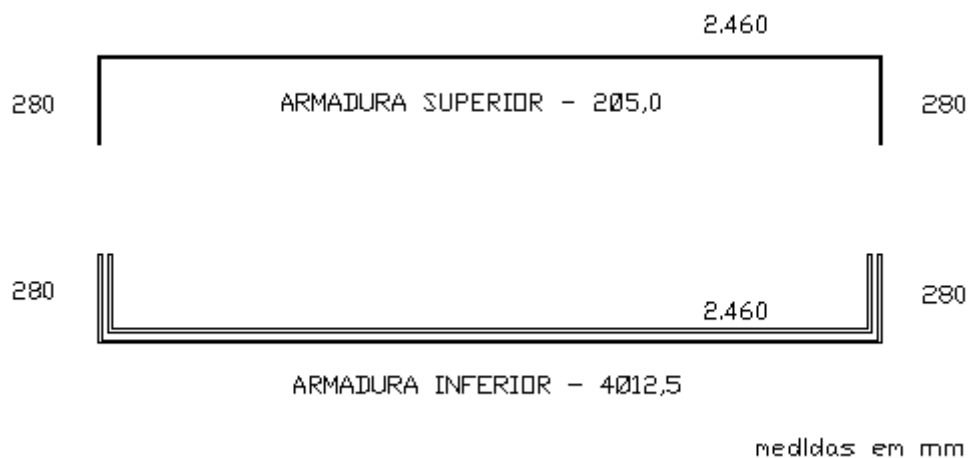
Armadura longitudinal das vigas VM2, VPF2, VPF5 e VPF8
